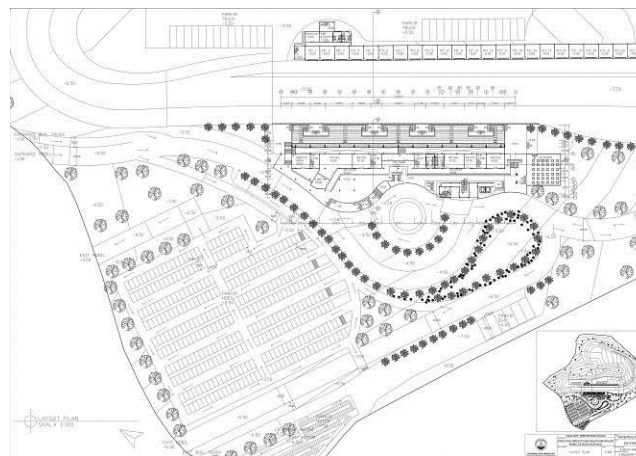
Tantanan Massa, Site Plan. Sumber: Penulis.
